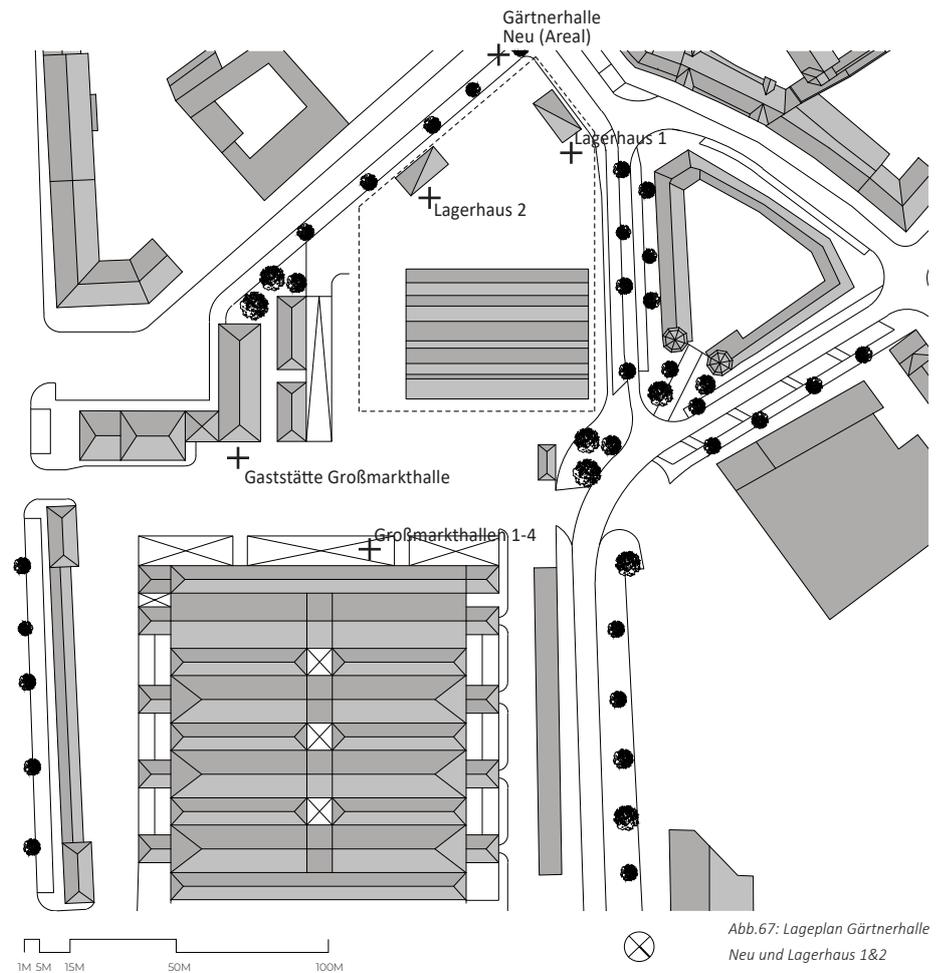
Lageplan Gärtnershalle Neu und Lagerhaus 1&2
